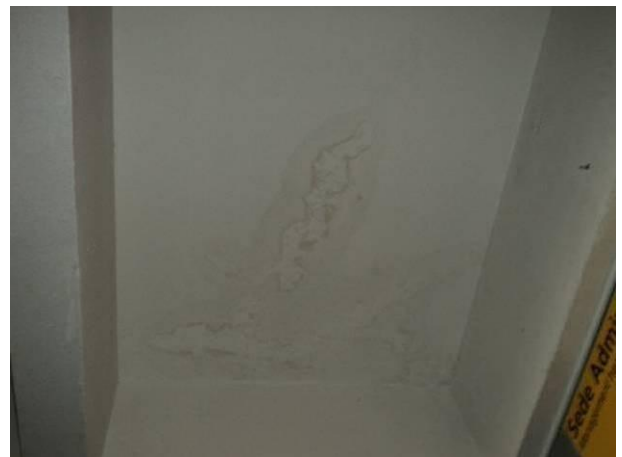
Manchas de umidade na laje entre os eixos 1/2 e I/J.
